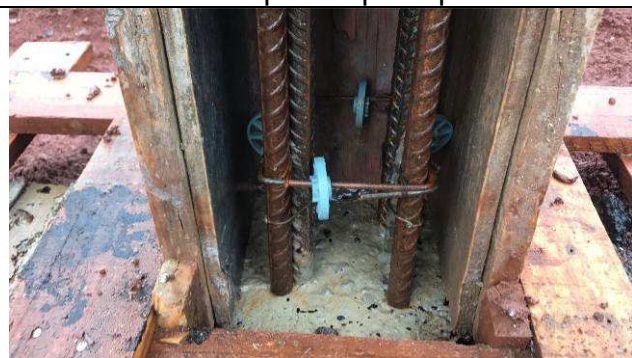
C: Formas e armaduras do pilar P45 do prédio principal.
